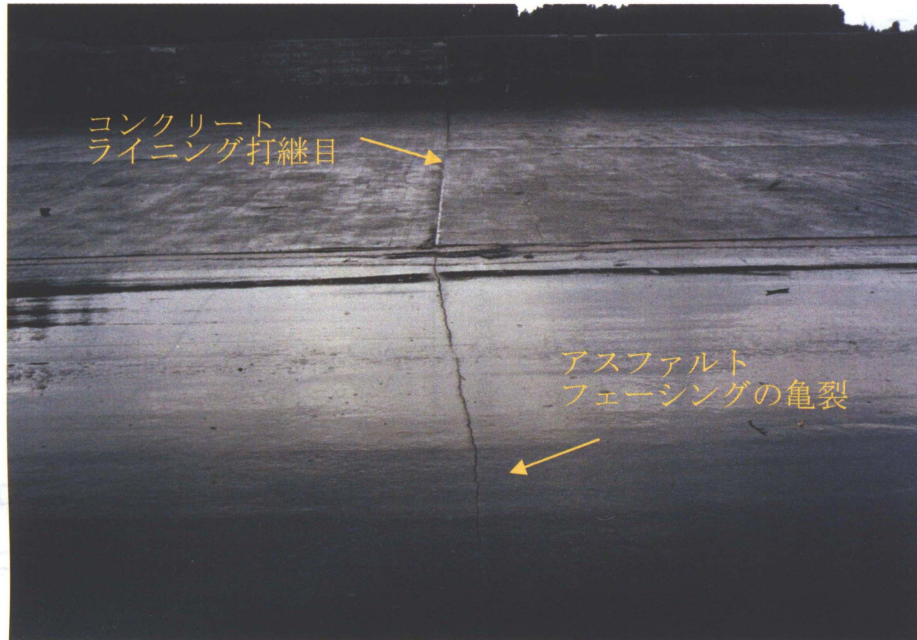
コンクリートライニングの打継目により生じた亀裂(N-13)
